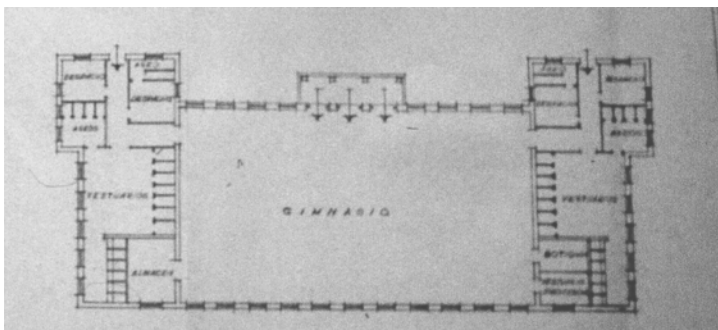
Gimnasio Universitario: planimetría, por F. Fuentes, J. M. Muguruza y J. Sáinz, hacia 1946.
